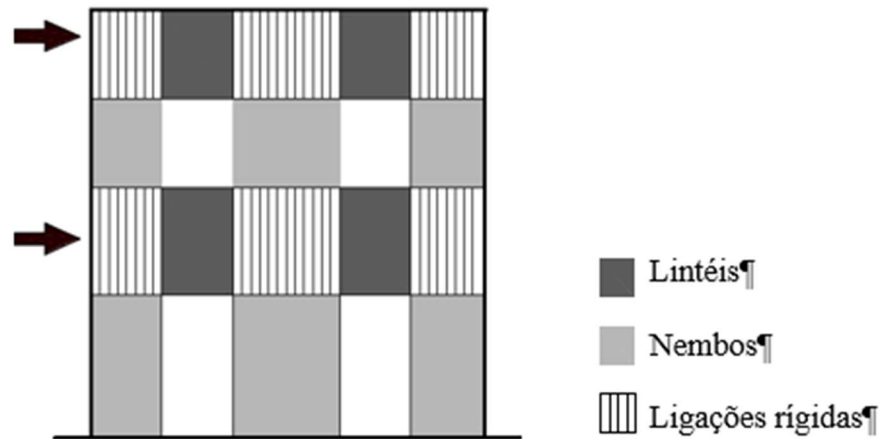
Parede típica em alvenaria de plano e principais elementos (Araujo, 2014)
